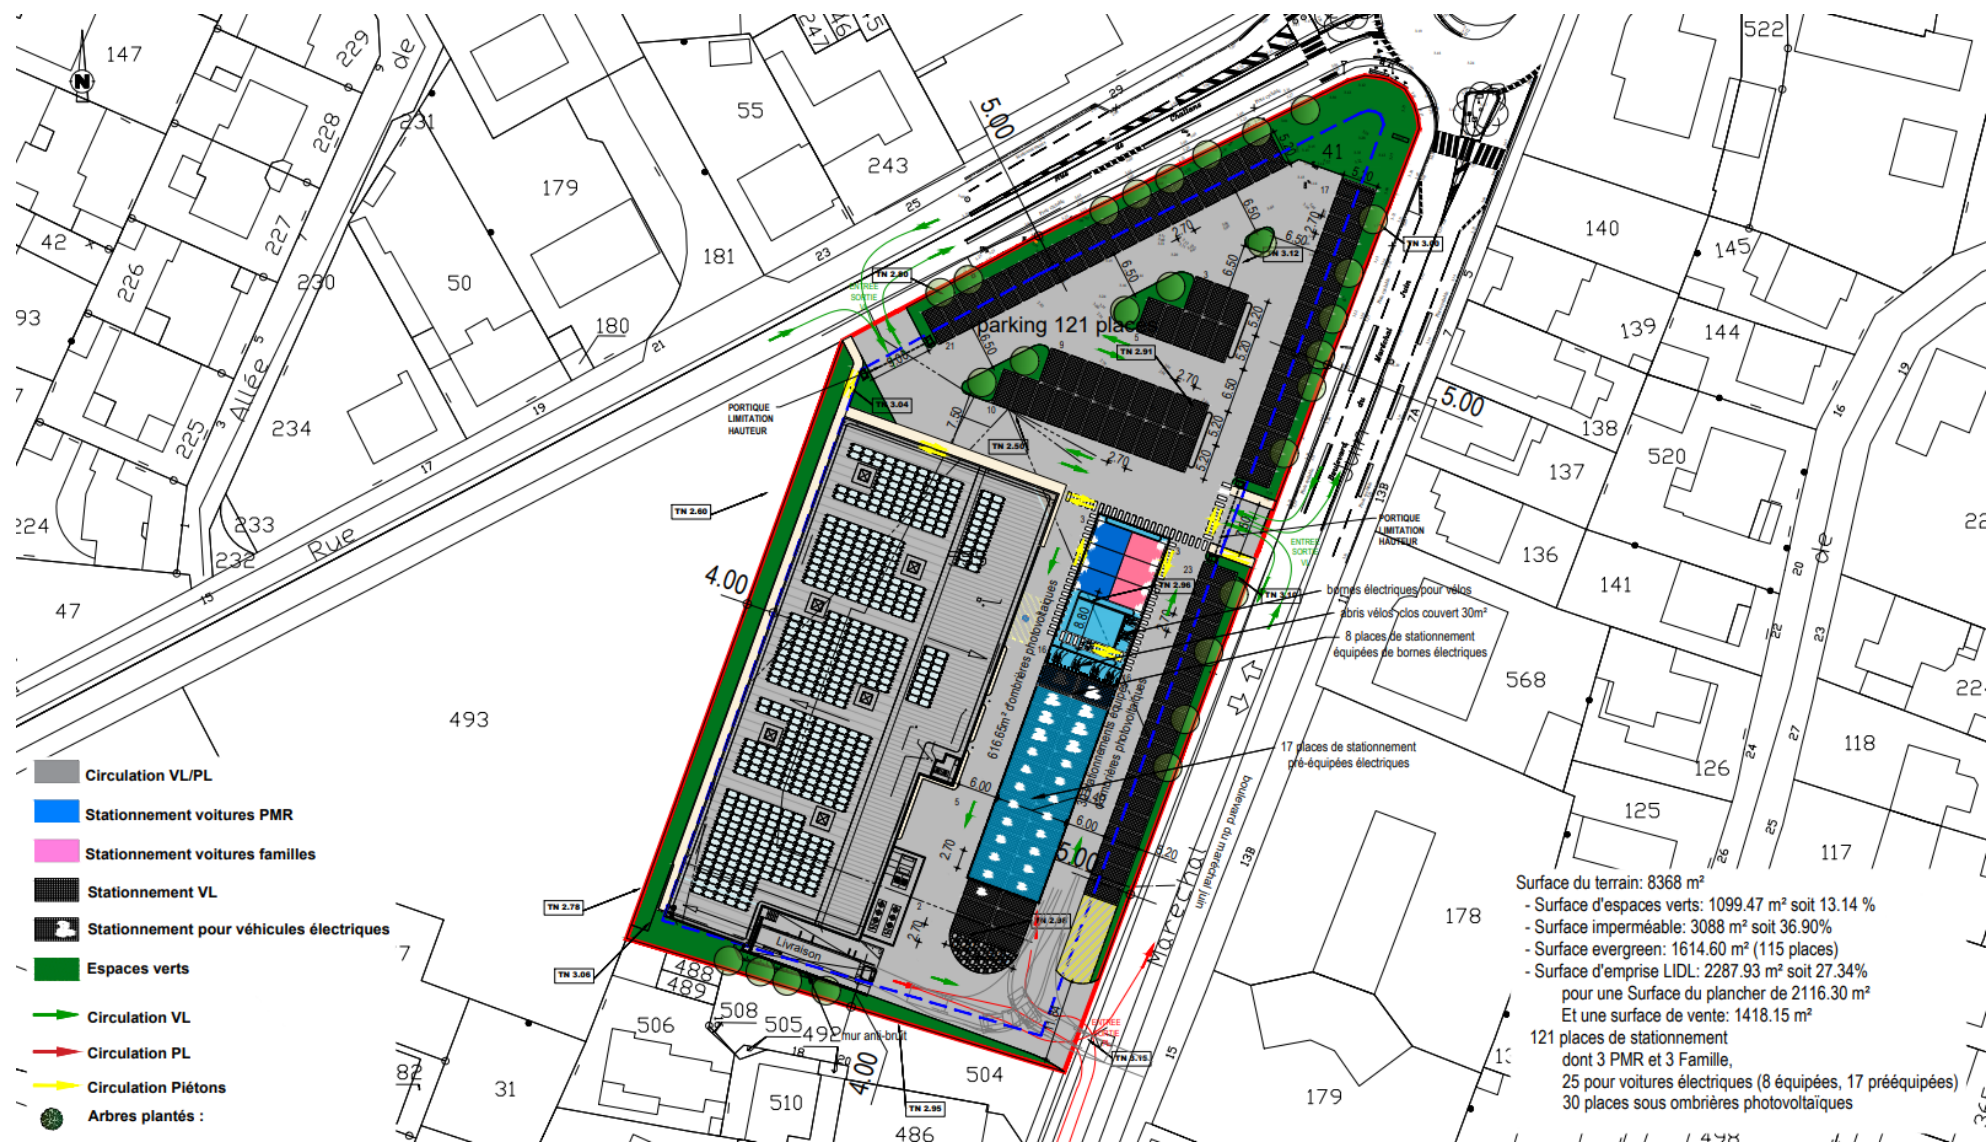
PLAN DU PROJET (SOURCE : BCF INGENIERIE)
